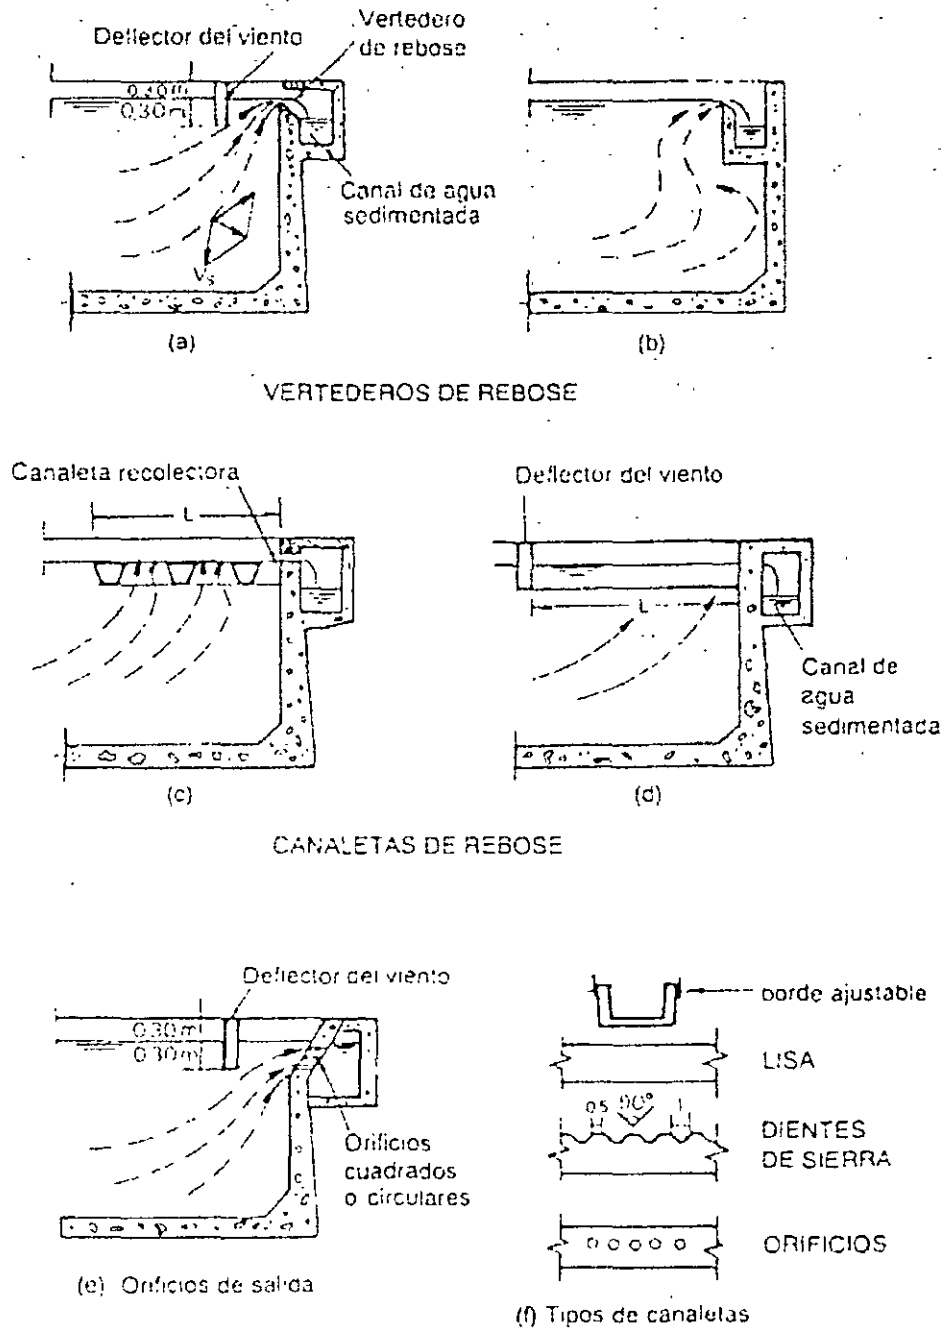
Estructuras de salida en sedimentadores rectangulares
